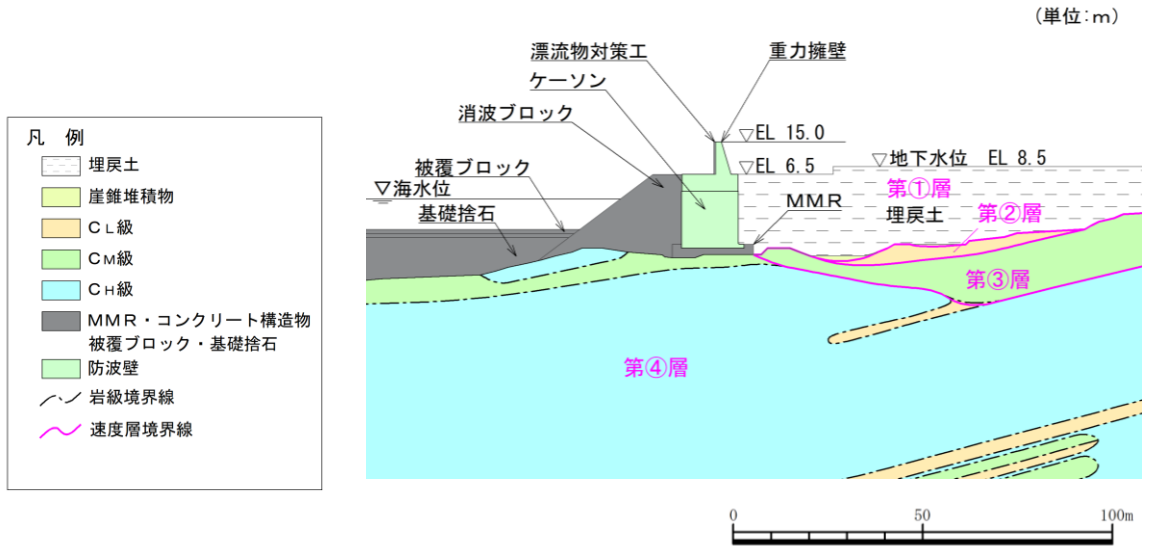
防波壁（波返重力擁壁）の横断面図（①-①断面）
